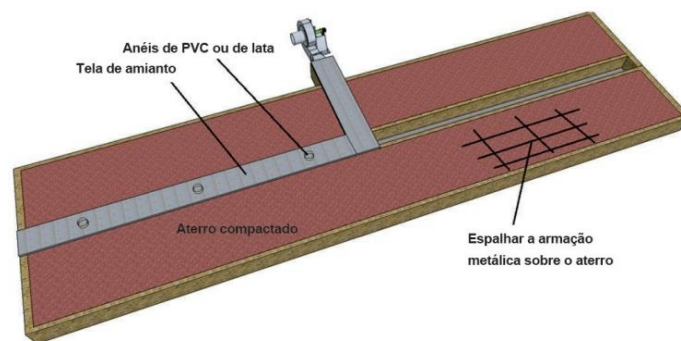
Desenho mostrando detalhes da construção do piso sobre aterro e dos canais com telhas de amianto.
